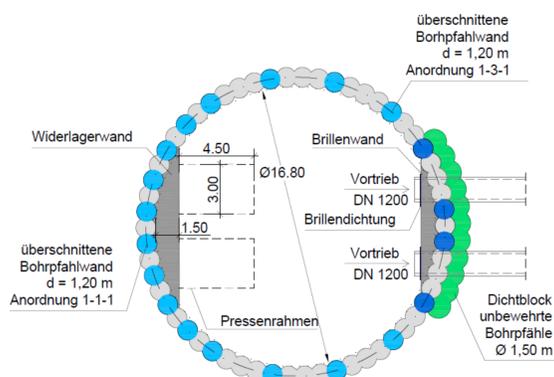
Grundriss, Variante A2, Querung (Q1)
